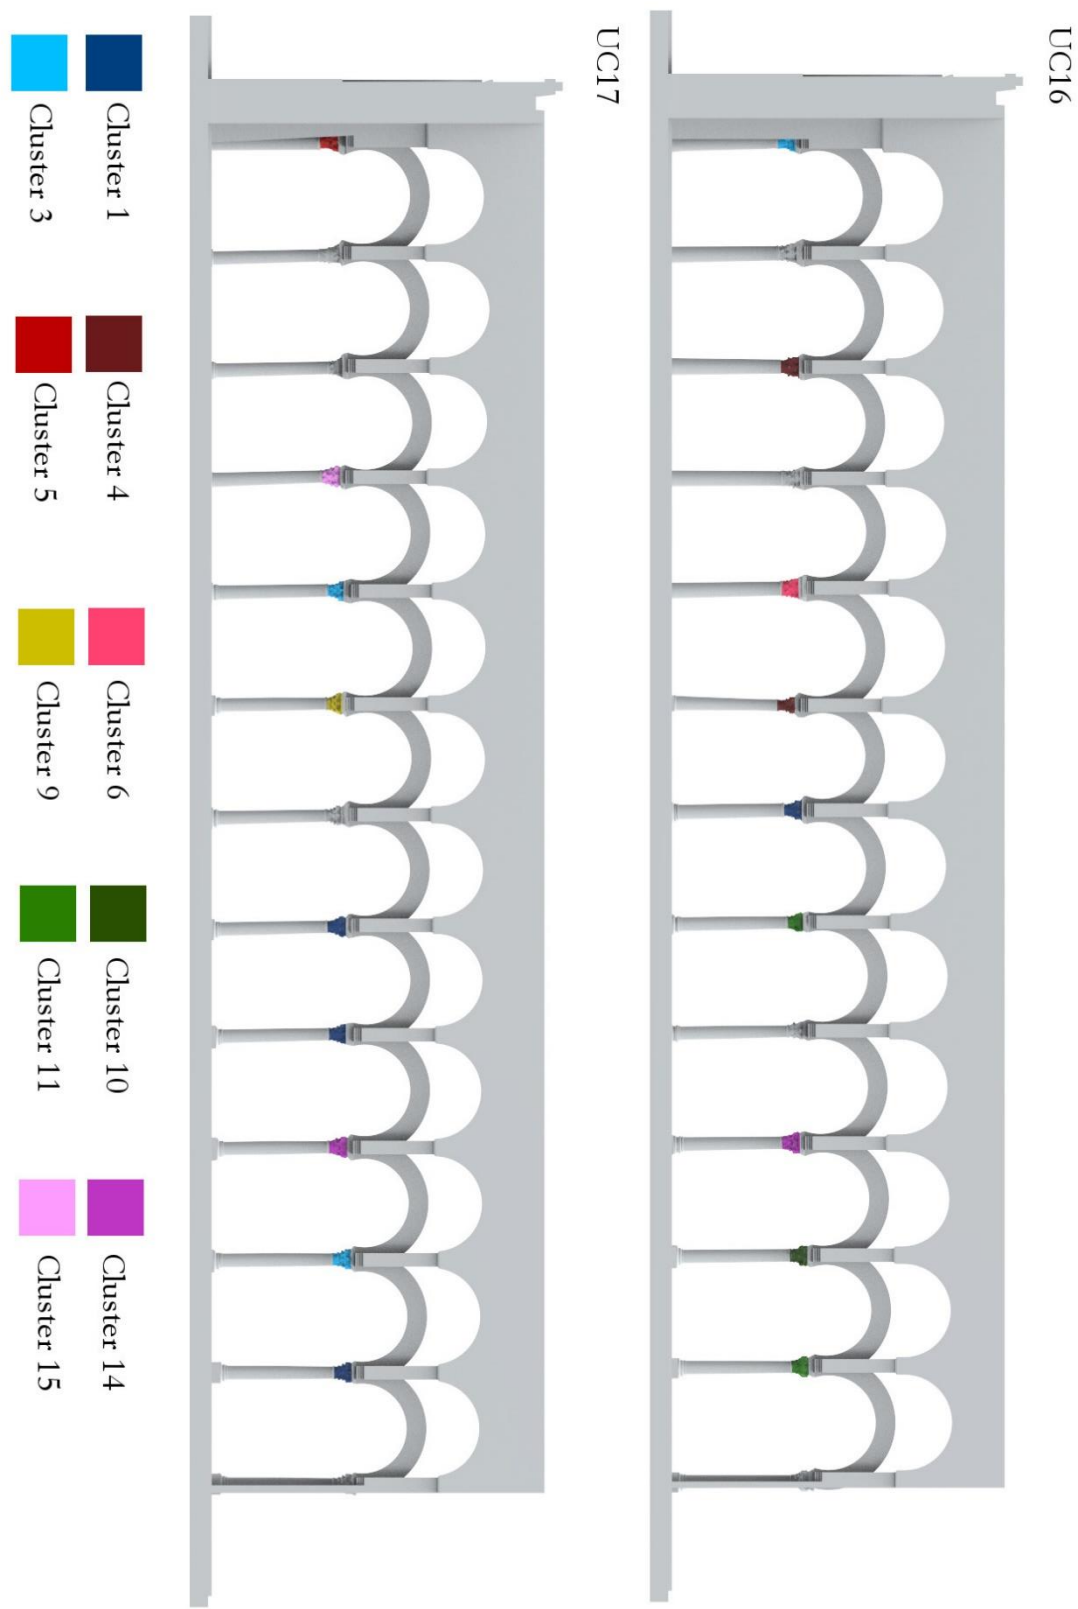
Alzado de las Unidades Constructivas (UC16-UC17) con los Clúster de los capiteles.
